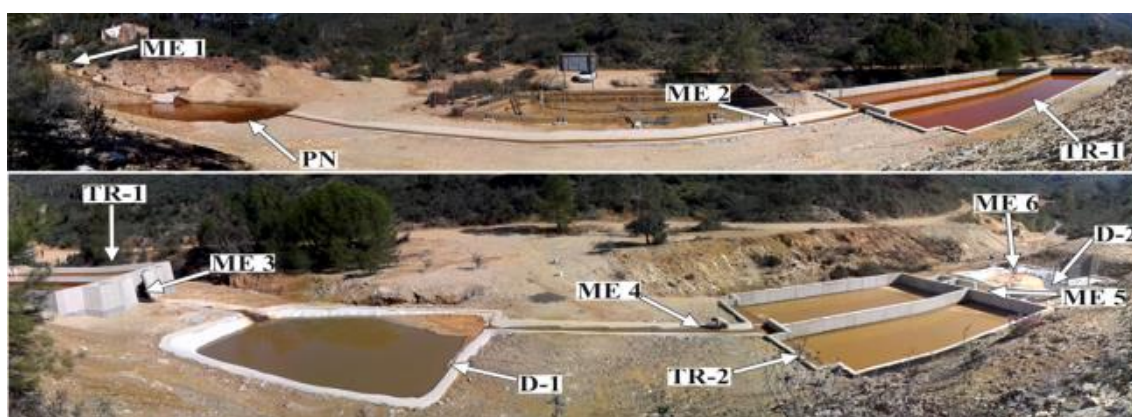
Imagen de la planta de tratamiento pasivo mediante tecnología DAS en Mina Esperanza, compuesta por tanques reactivos (TR) y decantadores (D).
